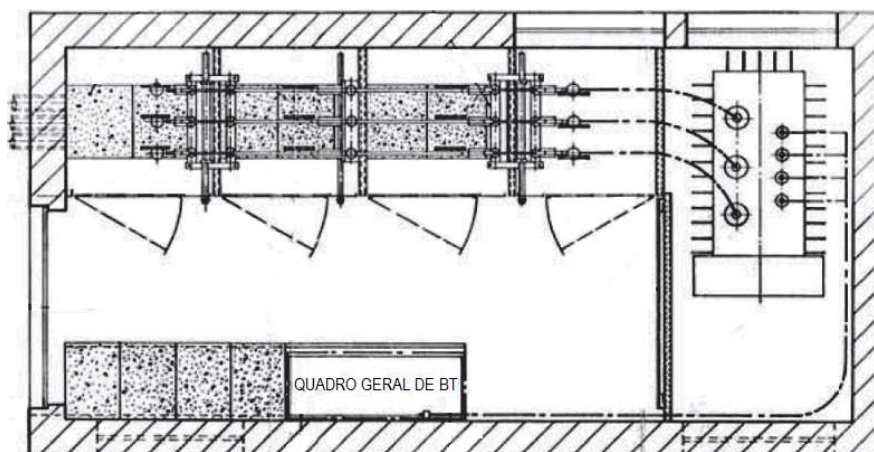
Planta de PT tipo CBL de construção tradicional [12]
